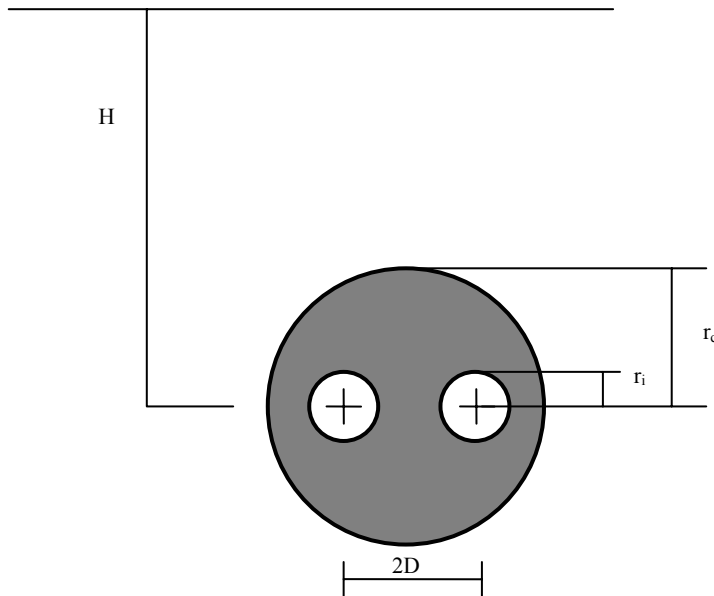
Asbestcementkulvert med cellbetong som isolering, dubbelrör.
